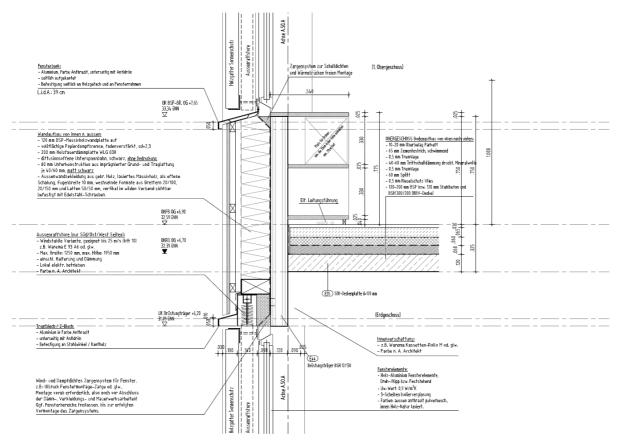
Fassadenschnitt - Anschluss Geschossdecke, Brüstungsträger, Fensteranschluss (IBUS Architekten)
